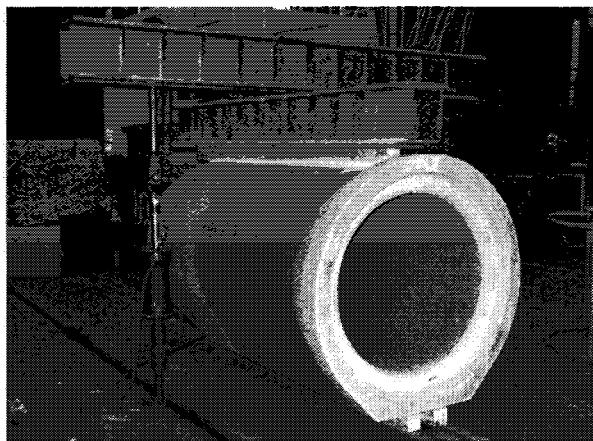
Испытание раструбной железобетонной трубы на прочность и трещиностойкость в испытательном центре
